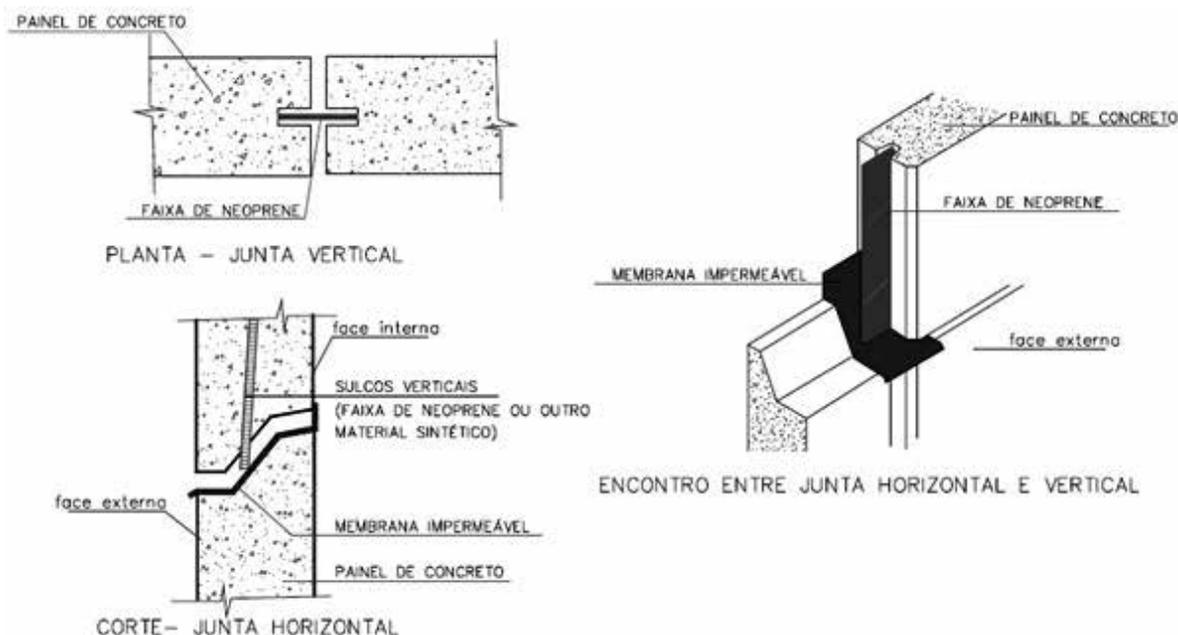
Detalhe de junta de drenagem e membrana estanques utilizadas nas juntas horizontais. (OLIVEIRA, 2002)
